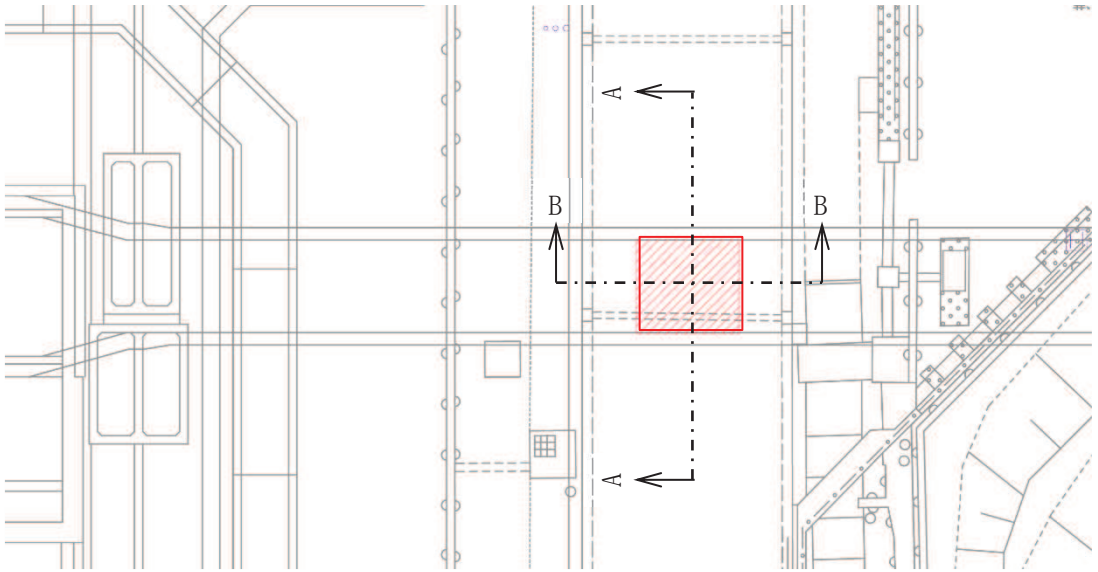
(1) 取放水路流路縮小工（第1号機放水路） 平面図
